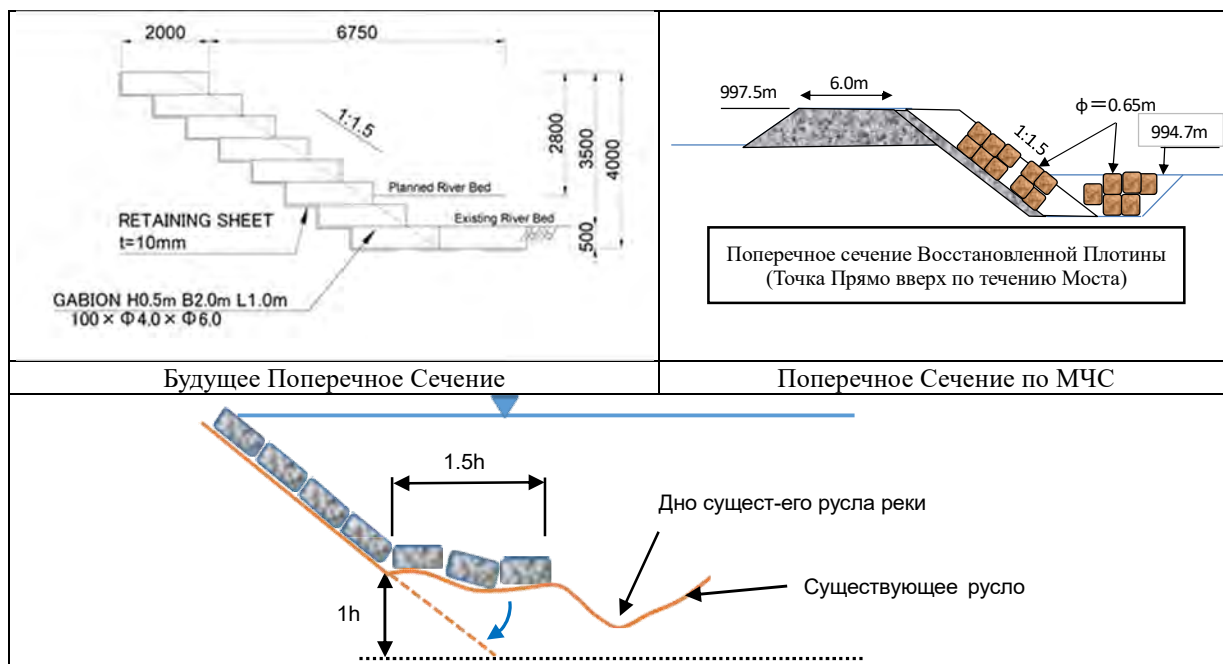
Поперечный план берегоукрепительных сооружений
